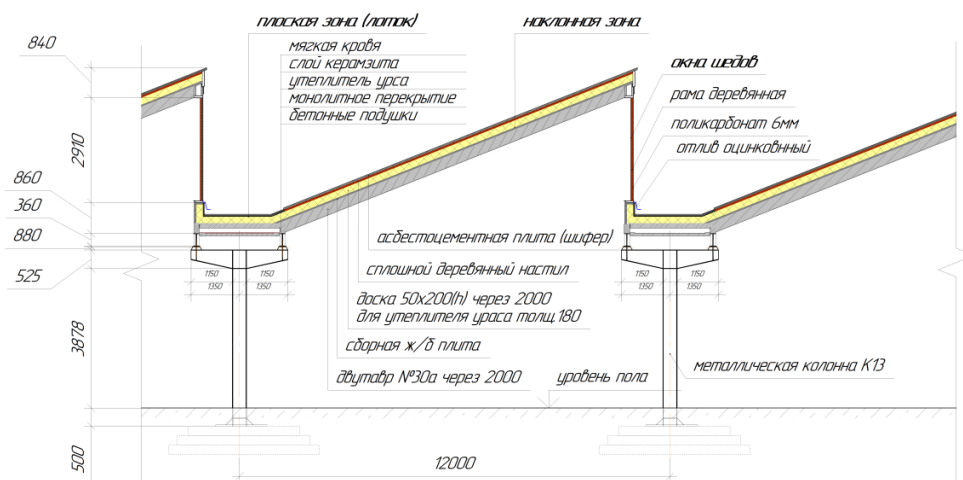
Поперечный разрез металлического каркаса с указанием плоских и наклонных зон устройства шедовой крыши
